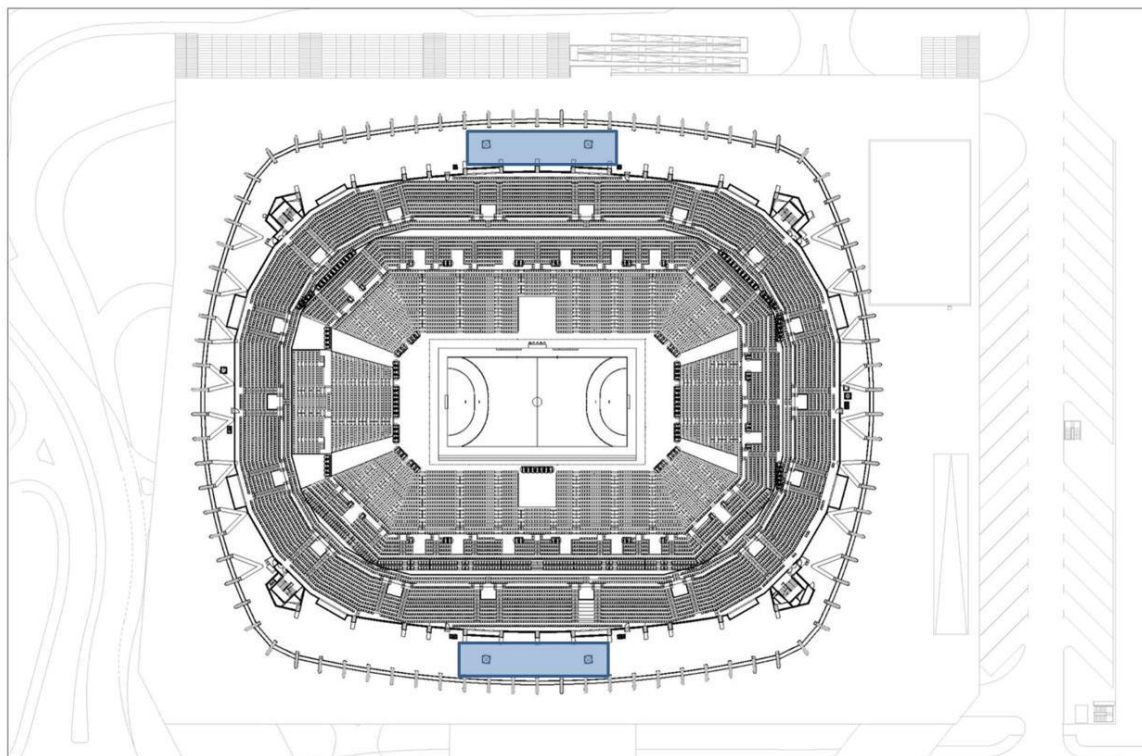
Plan du 4ème étage, Arena, Zagreb, Croatie.
